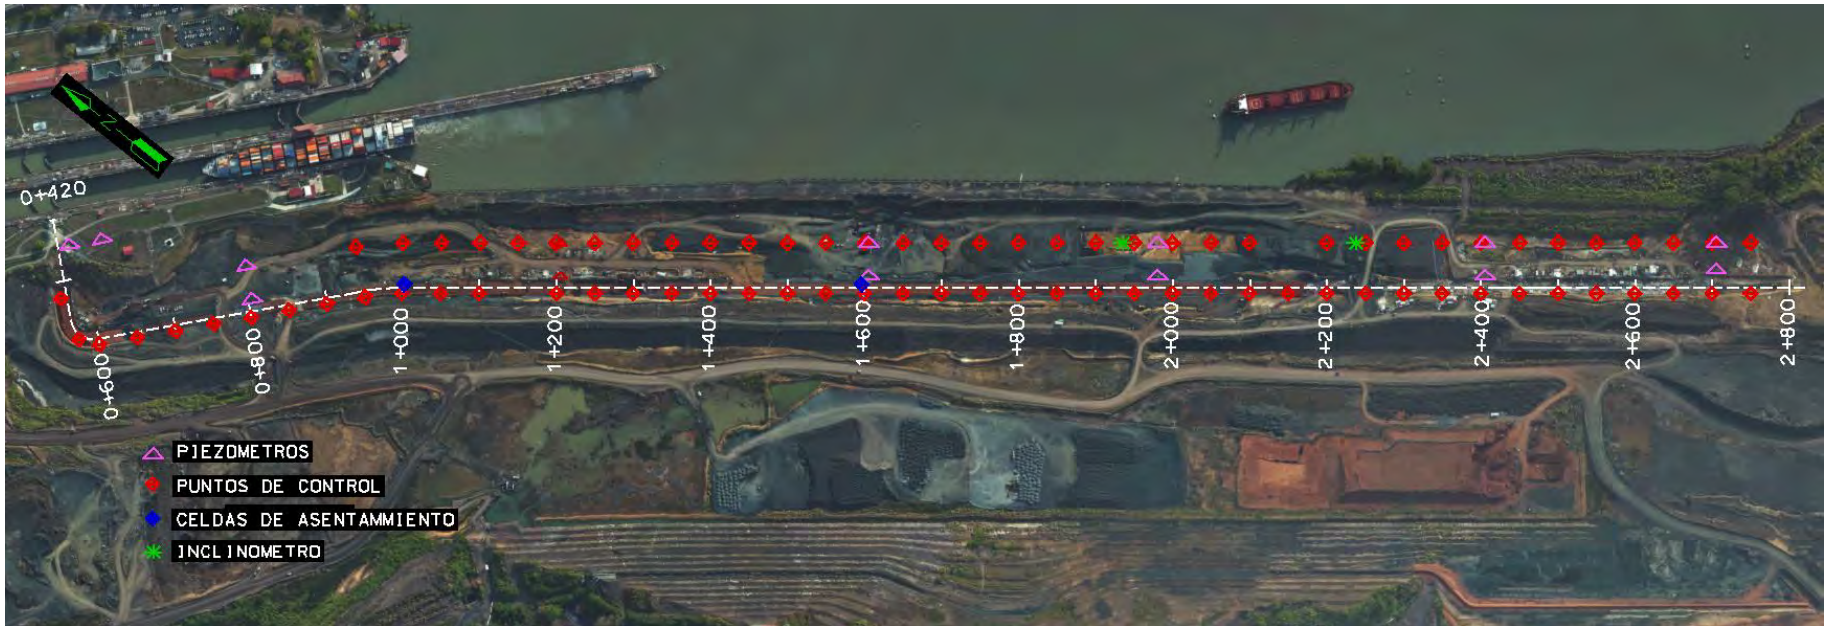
Planta de ubicación de instrumentación, fotografía del 2014
